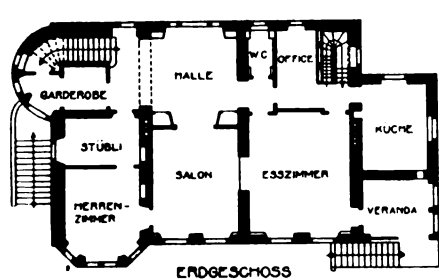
bis 6. Das „Waldschlössli“ bei Glarus. — Grundriss 1:400.
